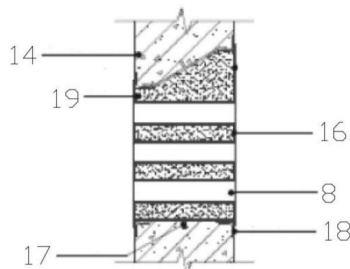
穿墙管群与混凝土侧墙之间连接结构示意图
